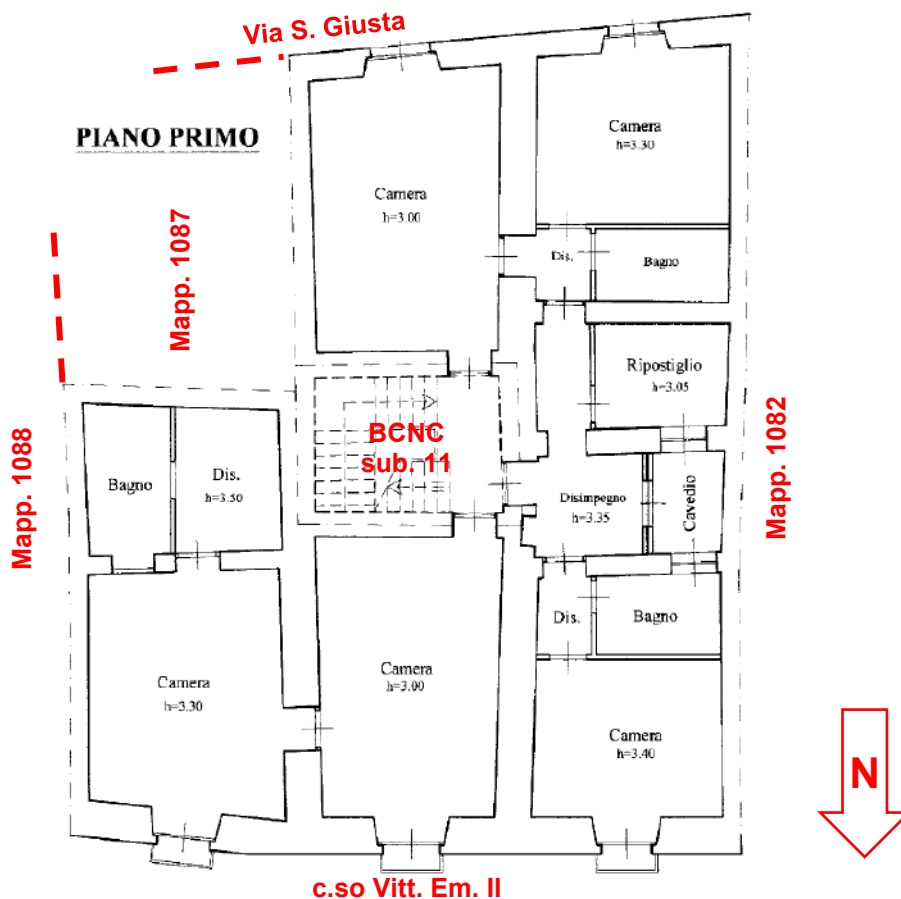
LOTTO 2. Planimetria catastale (fuori scala). Nord in basso
